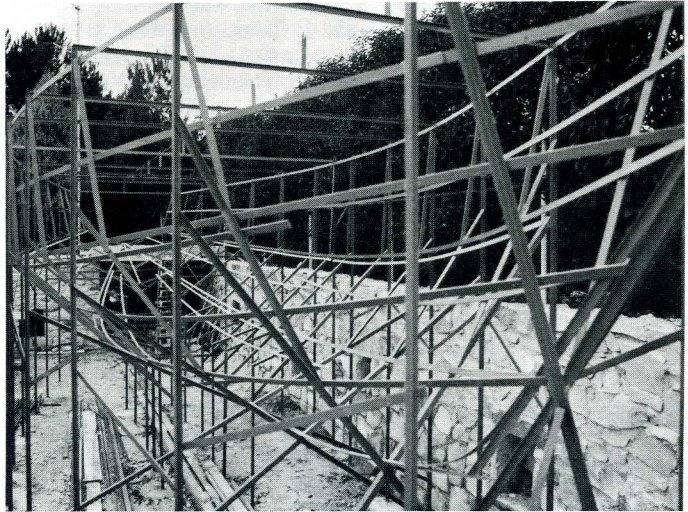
Ce polyester qui commence par le soudage de cornières en acier...
